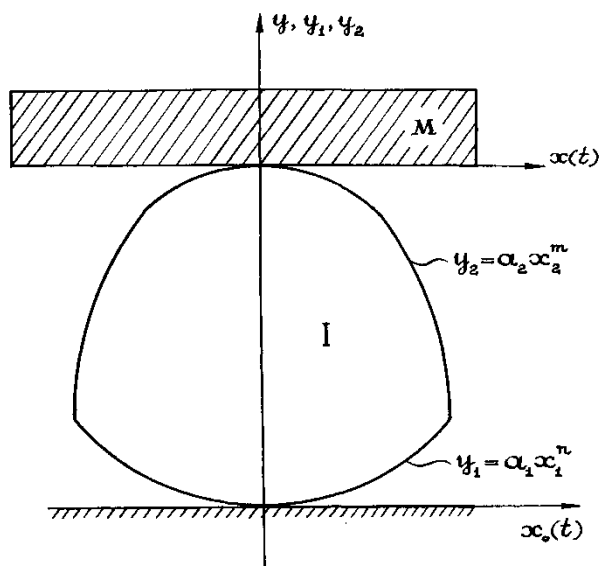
Схема опоры качения с опорными поверхностями высокого порядка.
